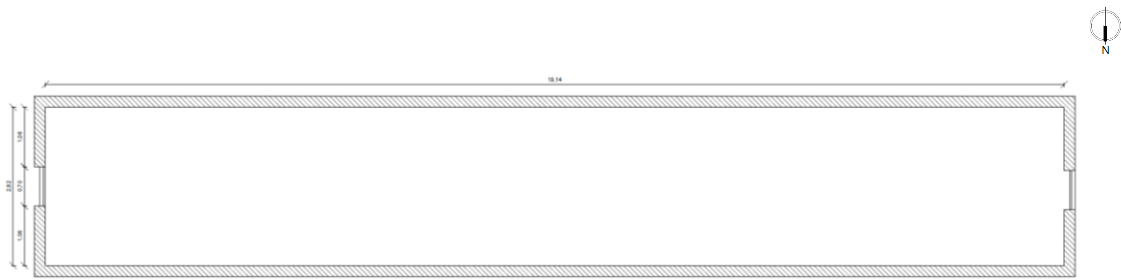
Planta de Levantamento Piso 2 sótão, Casa das Queimada.
